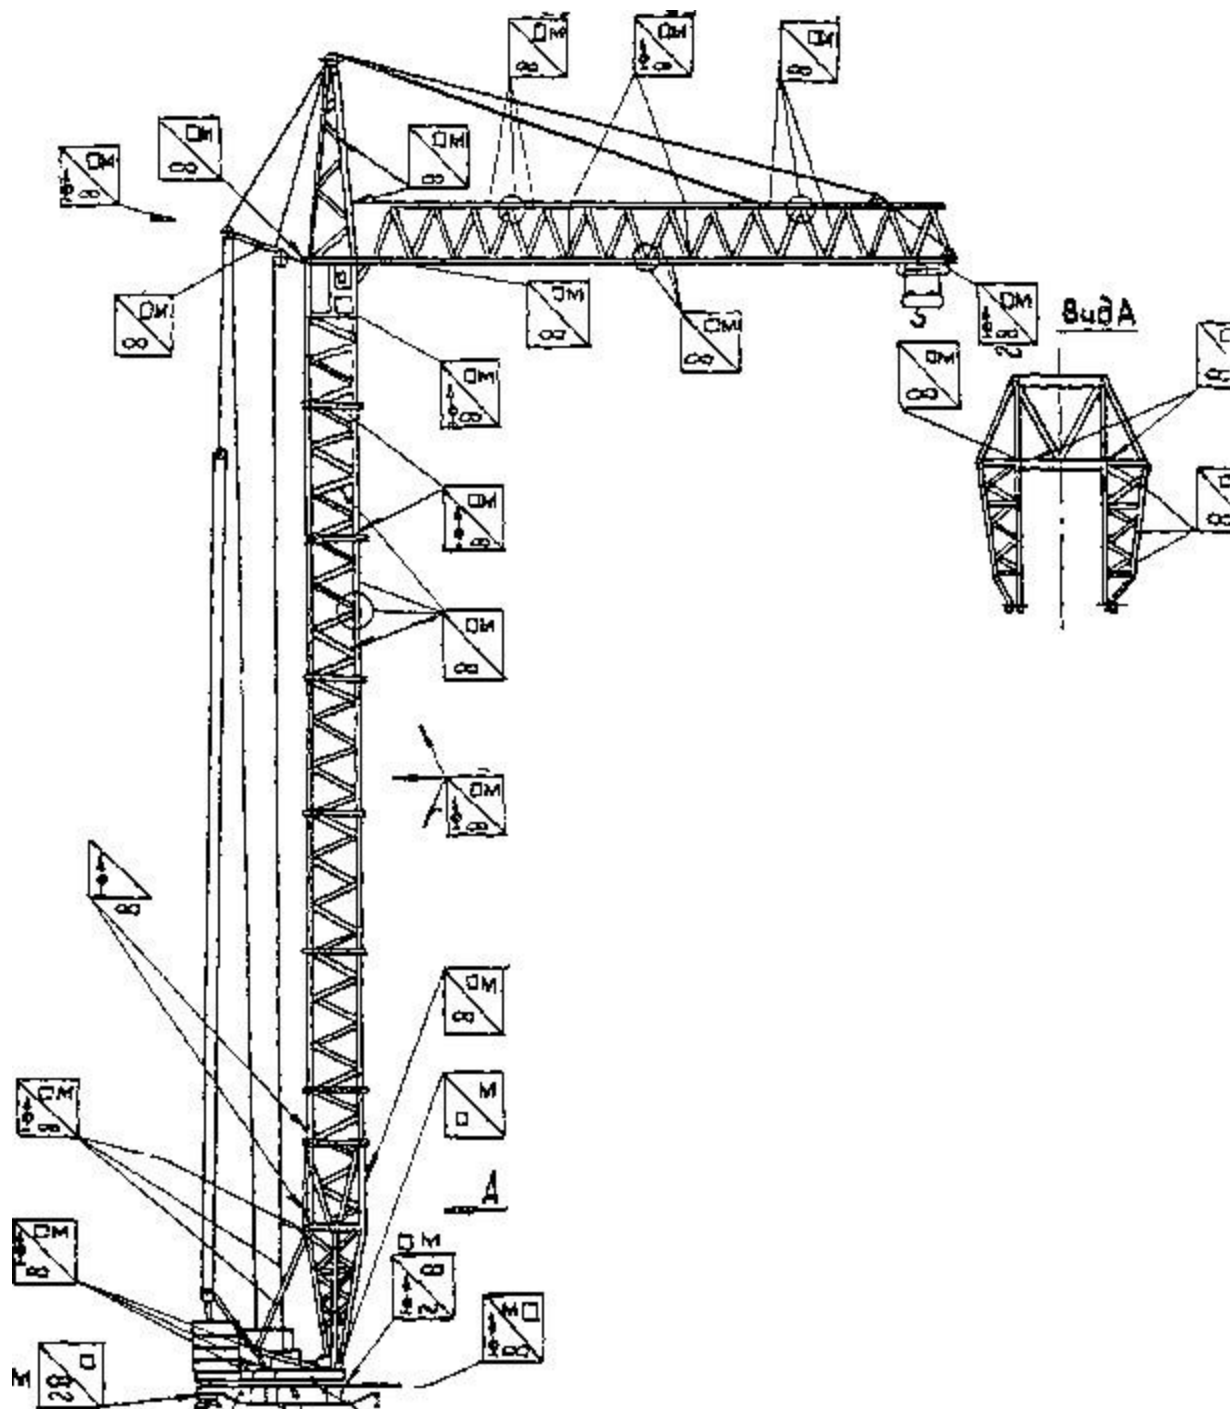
Схема к карте осмотра металлоконструкций строительного башенного крана с поворотной решетчатой башней, шарнирно закрепленной на ходовой раме с поворотными балками-флюгерами, и балочной стрелой
